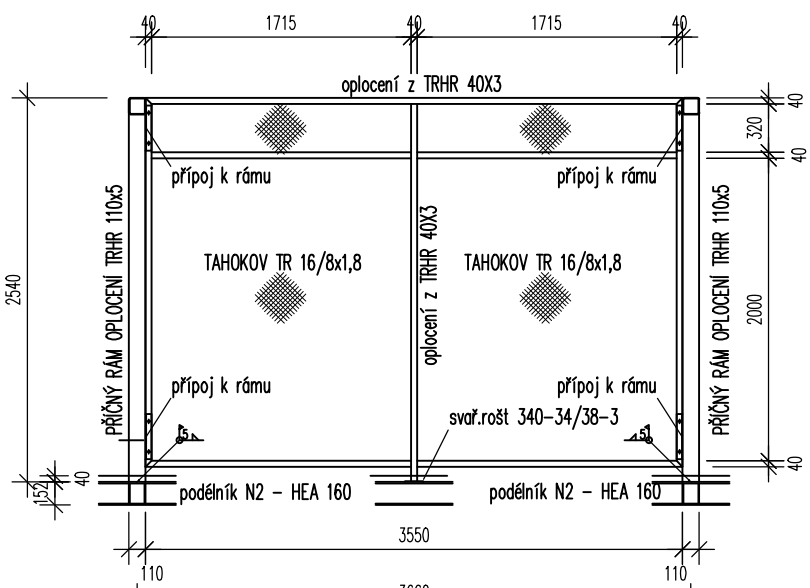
DETAIL PODPŮRNÝ RÁM (střední)-PODÉLNÍK N2
